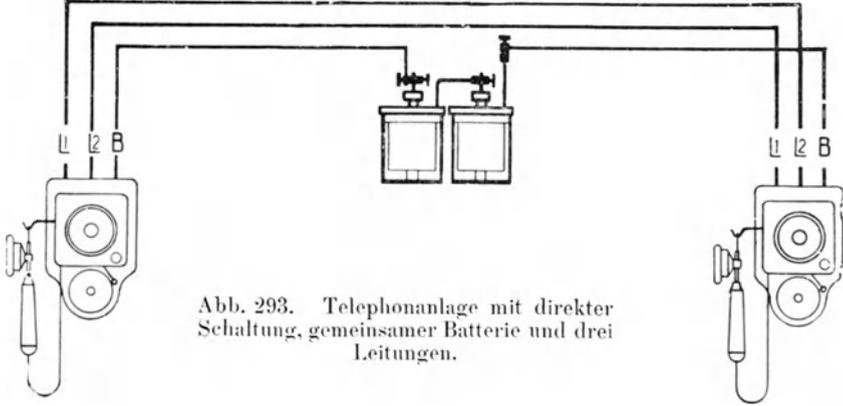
Telephonanlage mit direkter Schaltung, gemeinsamer Batterie und drei Leitungen.
